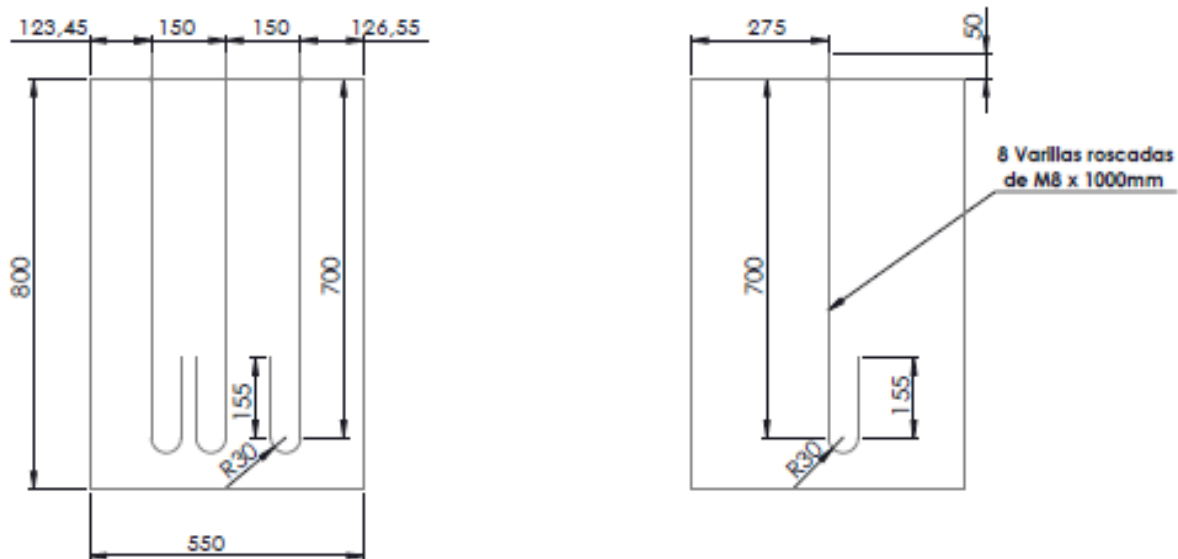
Esquema de cimentación representado en alzado y perfil. Unidades: mm Fuente: Elaboración propia
